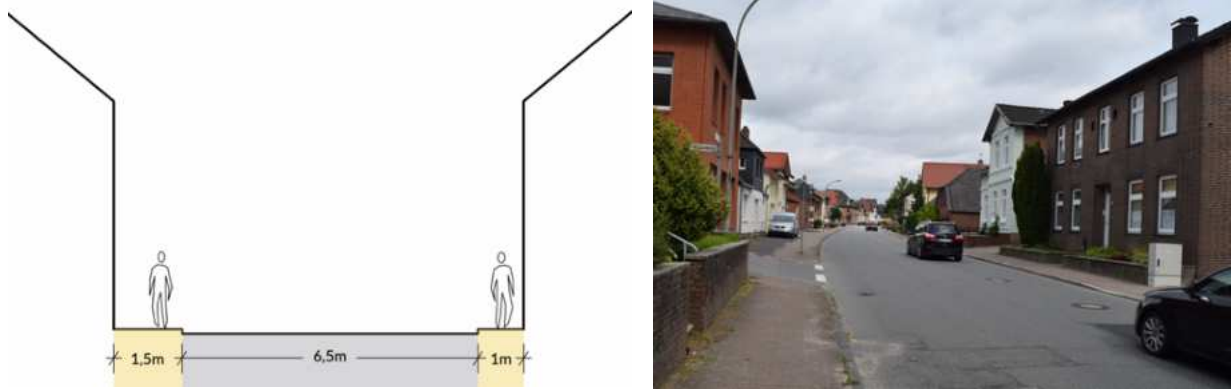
Straßenquerschnitt Lübecker Straße (an engster Stelle)
